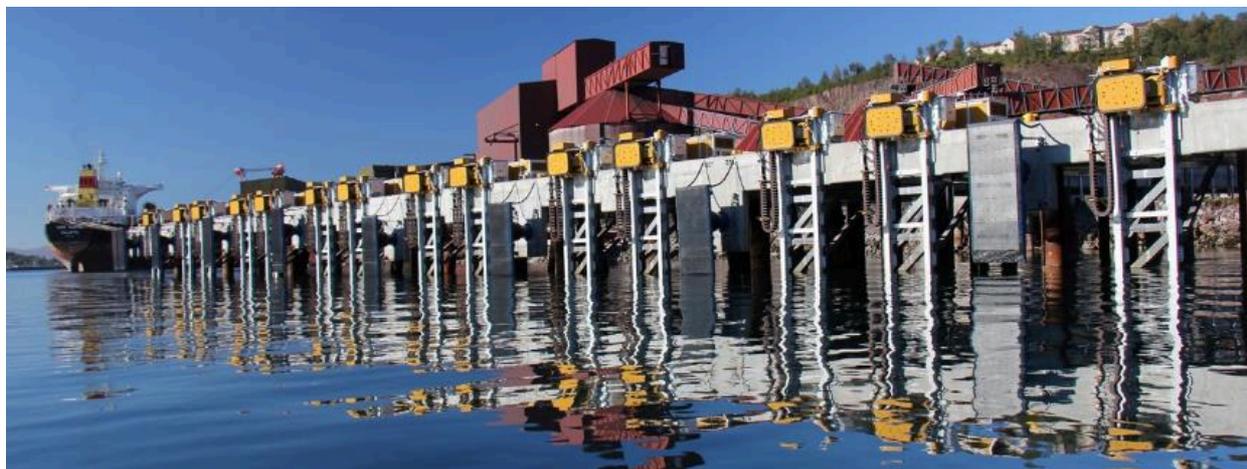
Vista desde el lado mar. Sistema de amarre automático en el Puerto de Narvik (Noruega). Fuente: Cavotec
